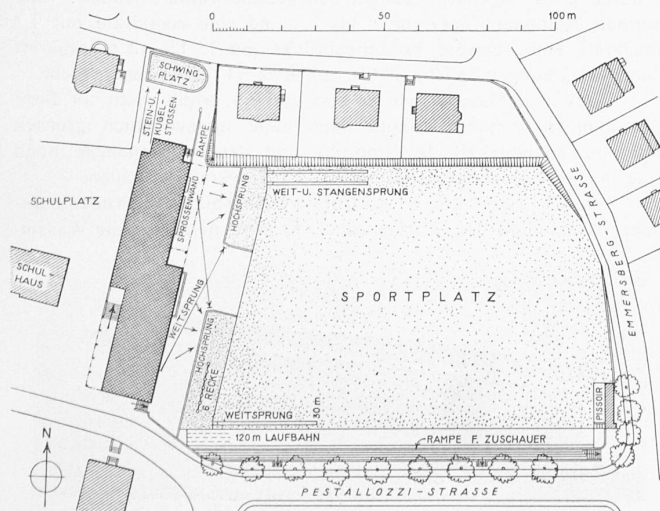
Lageplan der Turnhallen Emmersberg. — 1 : 2000.
